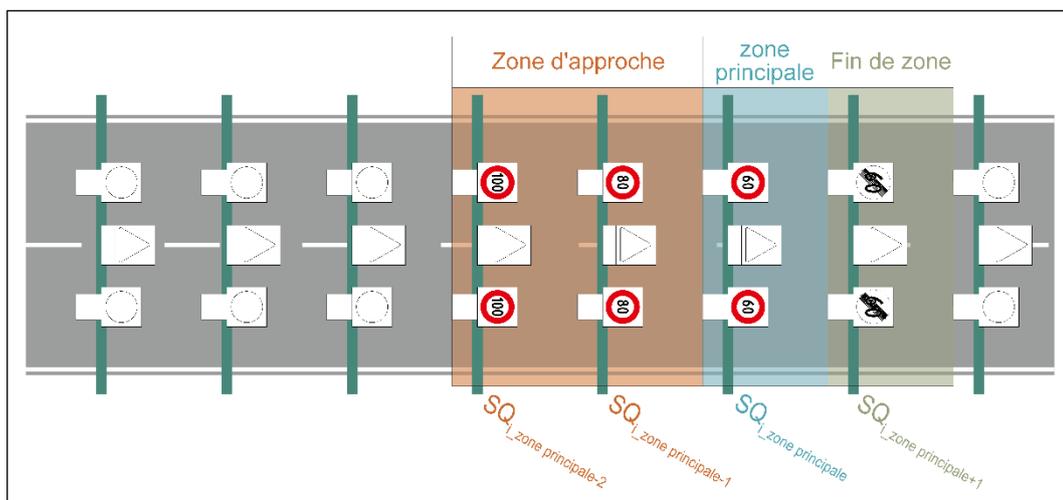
Structure d'un plan de feux (exemple V60 km/h)
